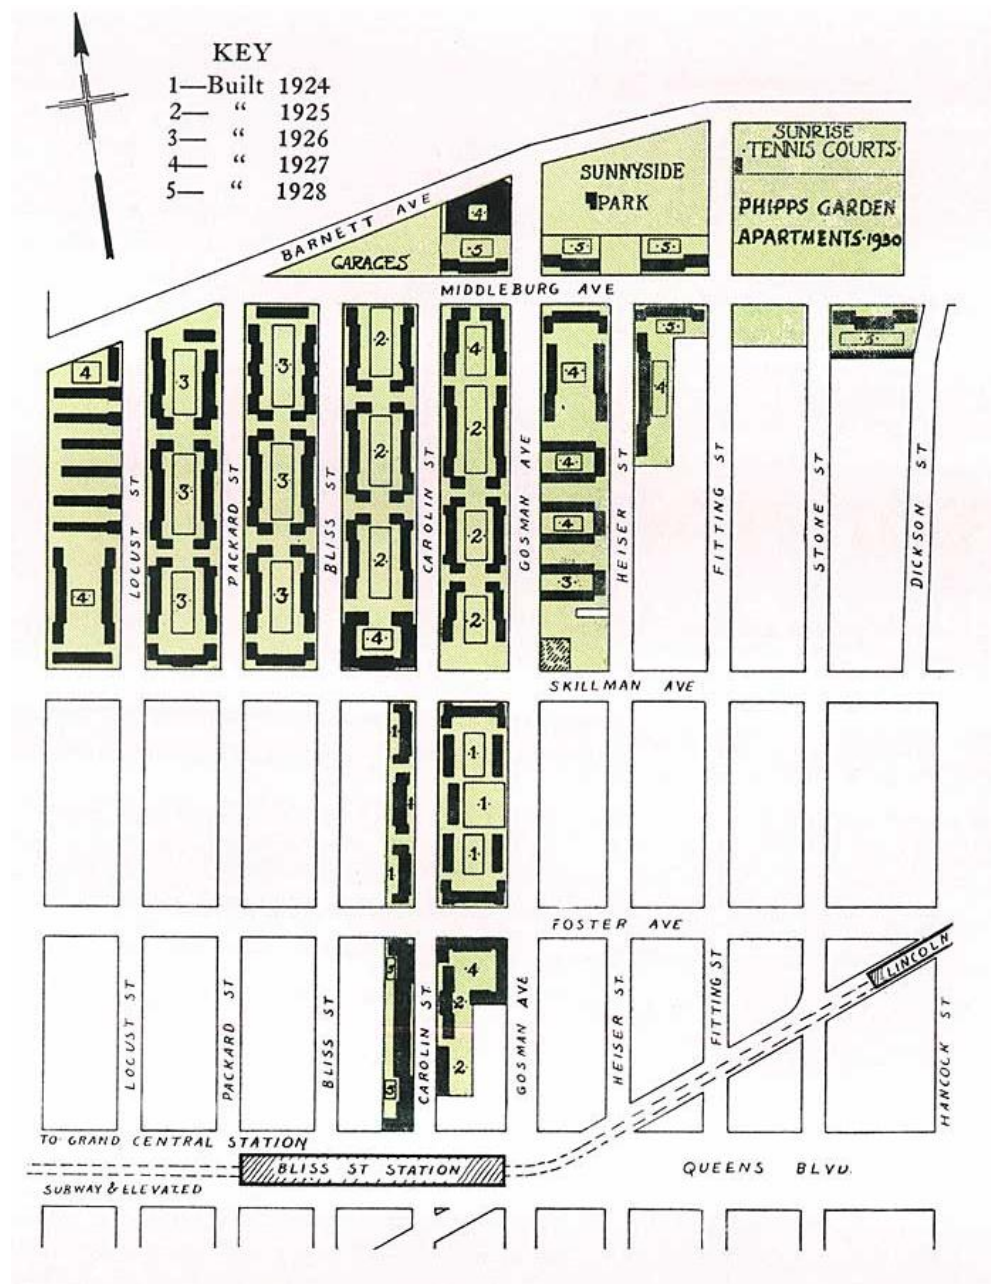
Planta de conjunto de Sunnyside Gardens. Fuente: sunnysidegardens.us
